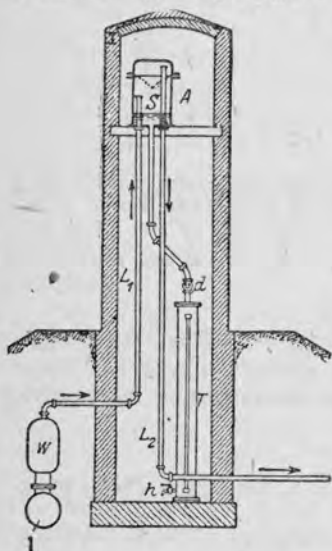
Вентиляционная башня каптажа грунтовой воды в городе Праге.
